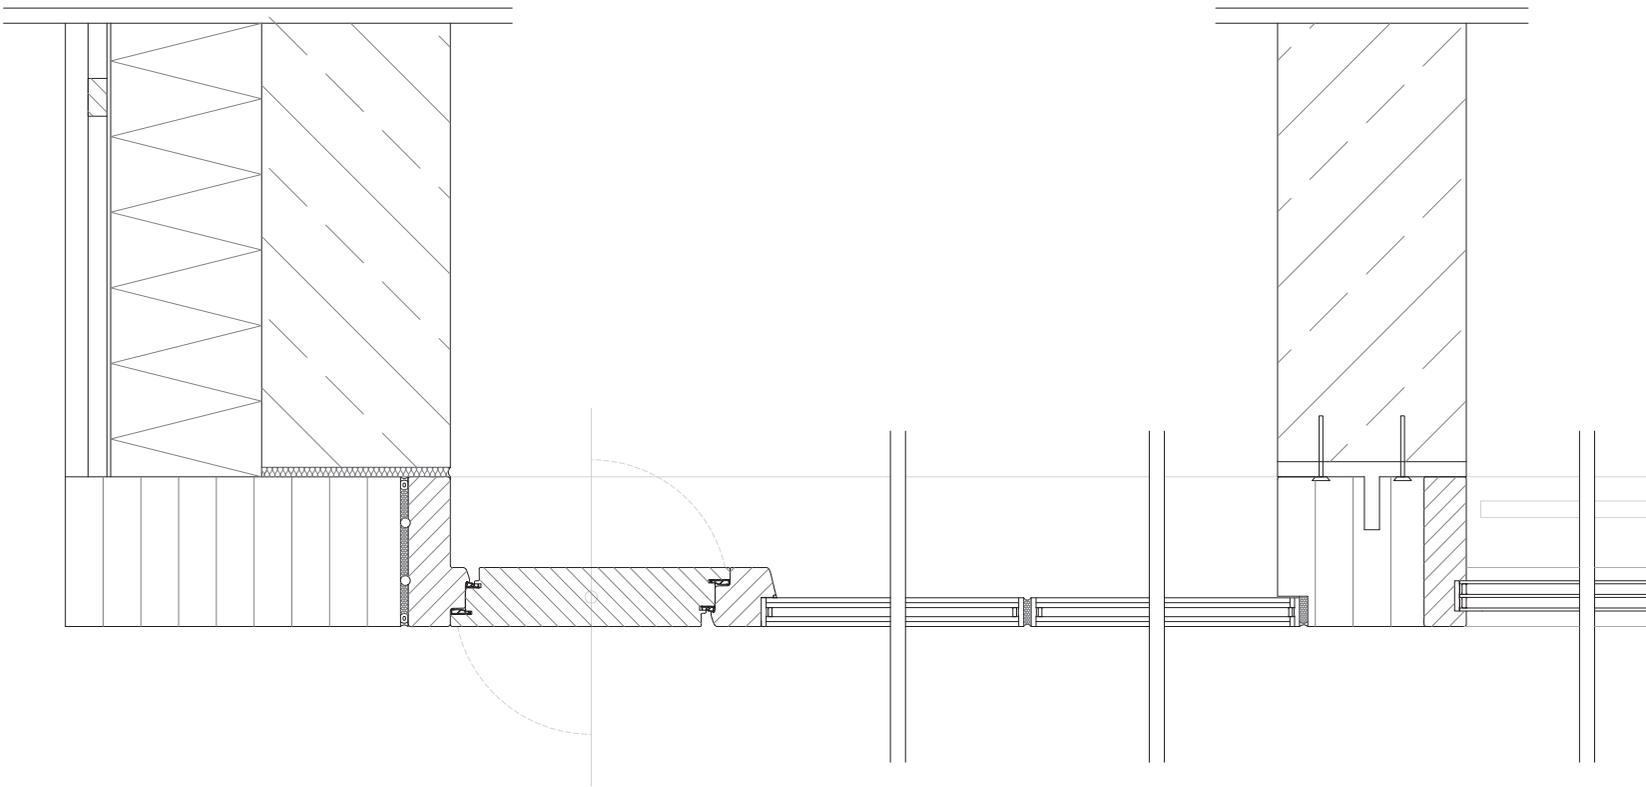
Horizontalschnitt Glasfassade EG M1:10
